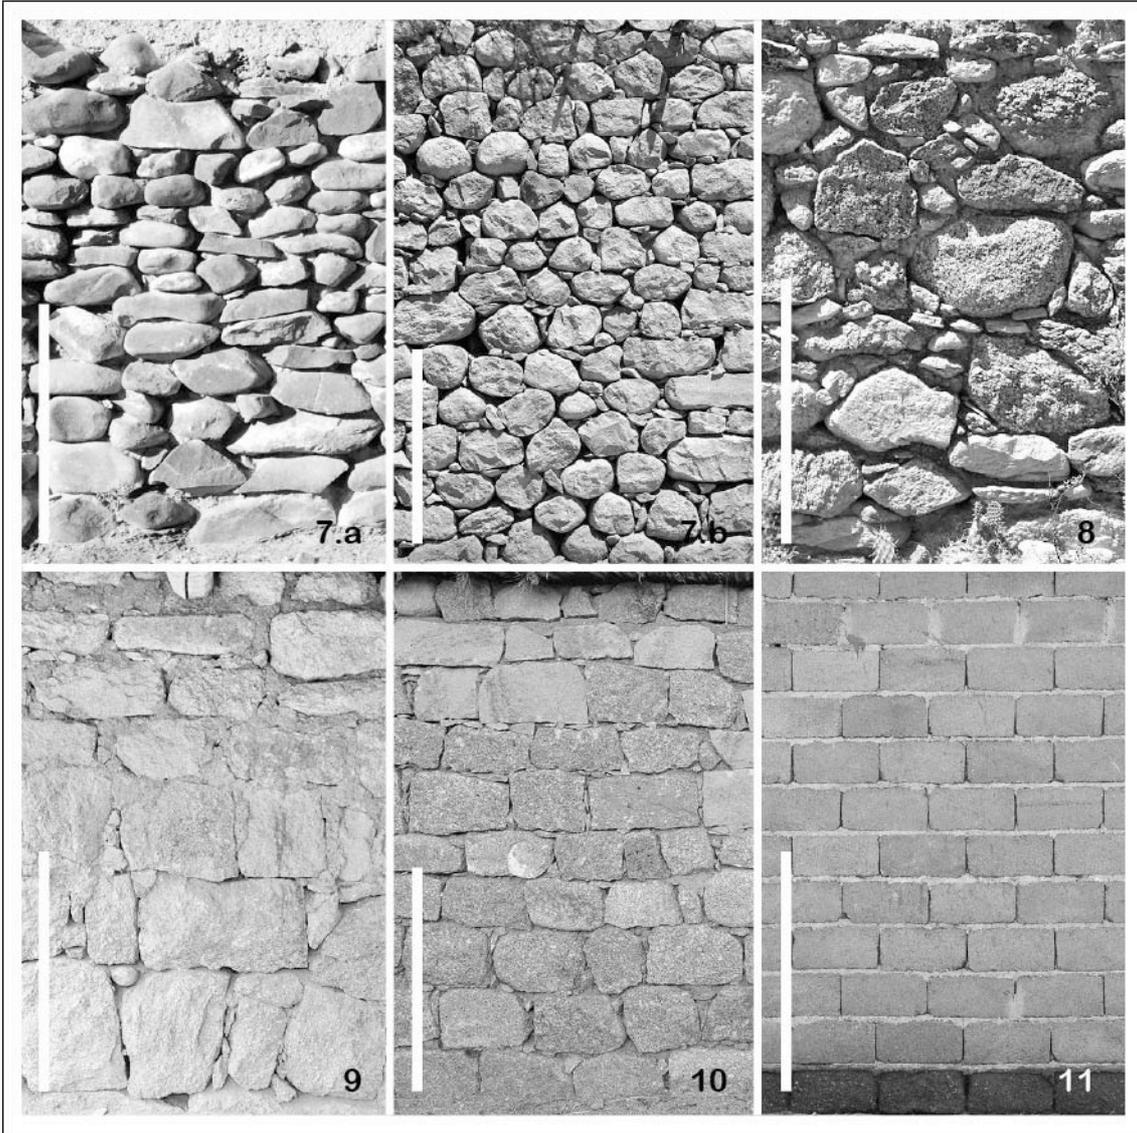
(Cont.). Muros de piedra y bloque de cemento. Barra: 1m.
